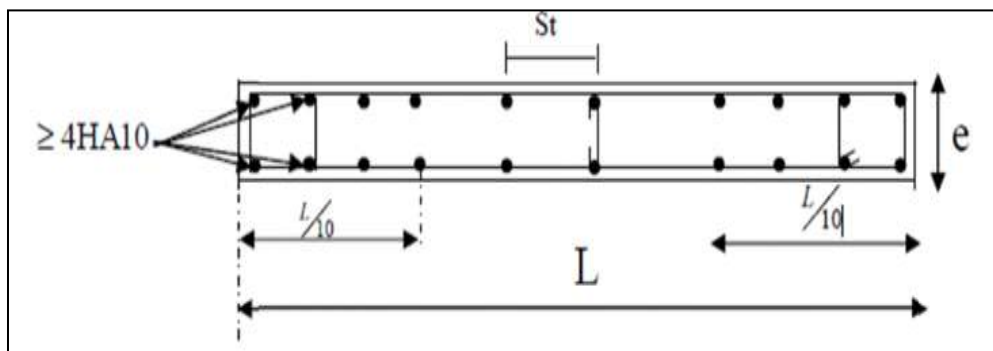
Disposition des armatures verticales dans les voiles
